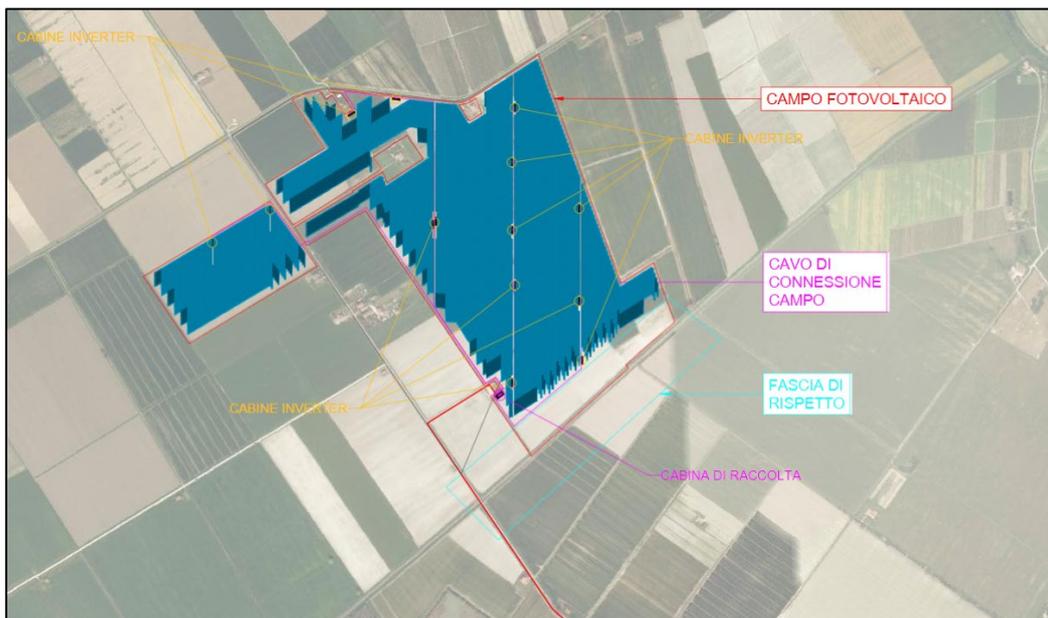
Stralcio della TAV.2.1 Layout impianto fotovoltaico su ortofoto
